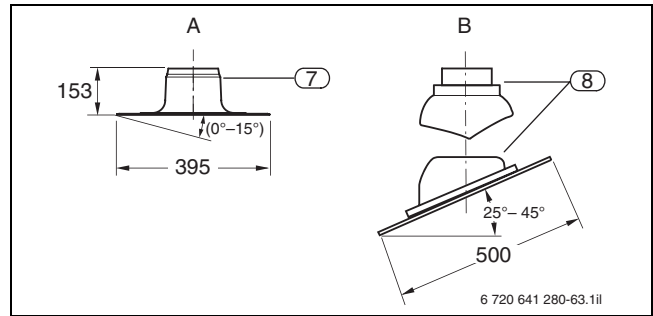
Universal-Dachziegel und Flachdach-Klebeflansch als Zusatzausstattung für den Grundbausatz DO (unbedingt mitbestellen); (Maße in mm)
